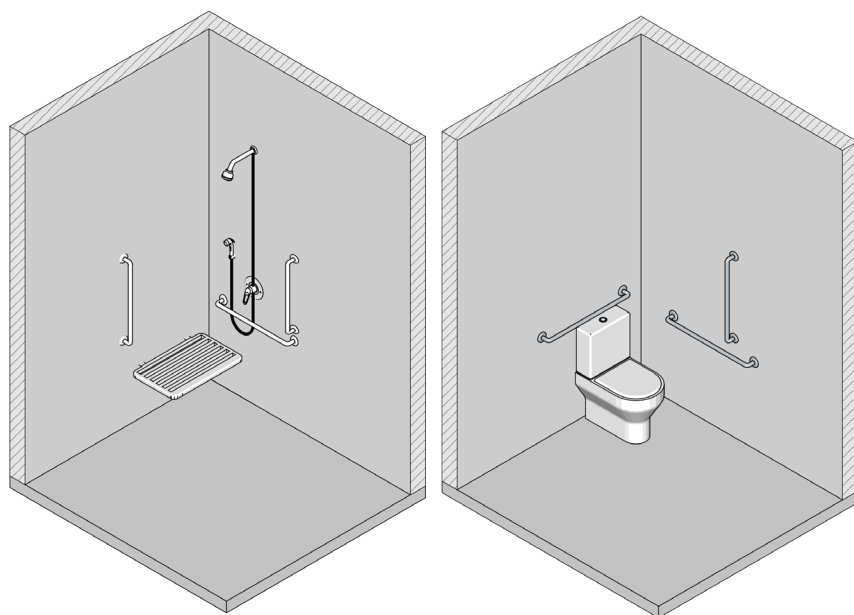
Modelo de aplicação de barras em banheiro (área de banho e vaso sanitário)
